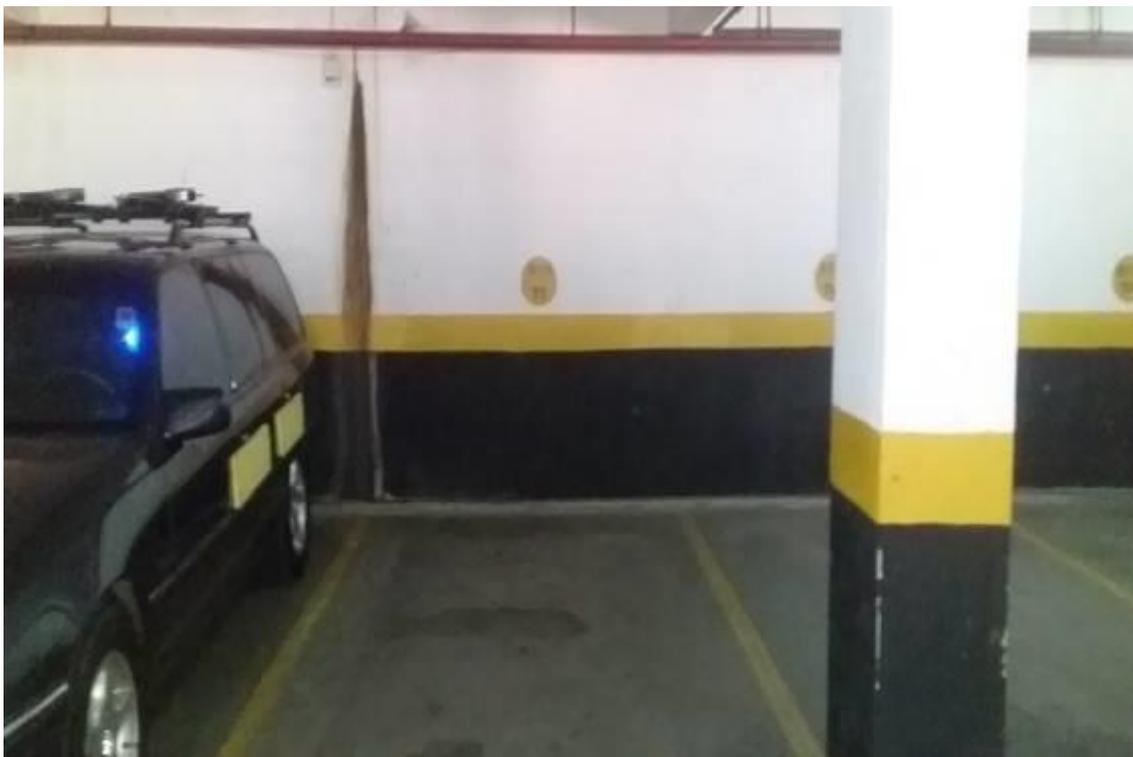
Vista da vaga de garagem de nº 77.
